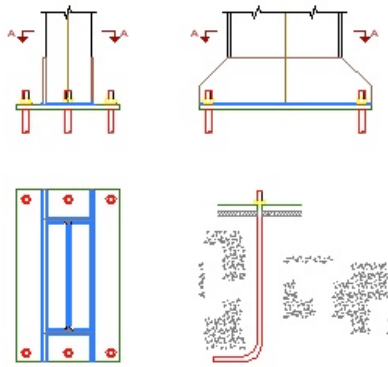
Placa de anclaje de los pilares del pórtico interior.
